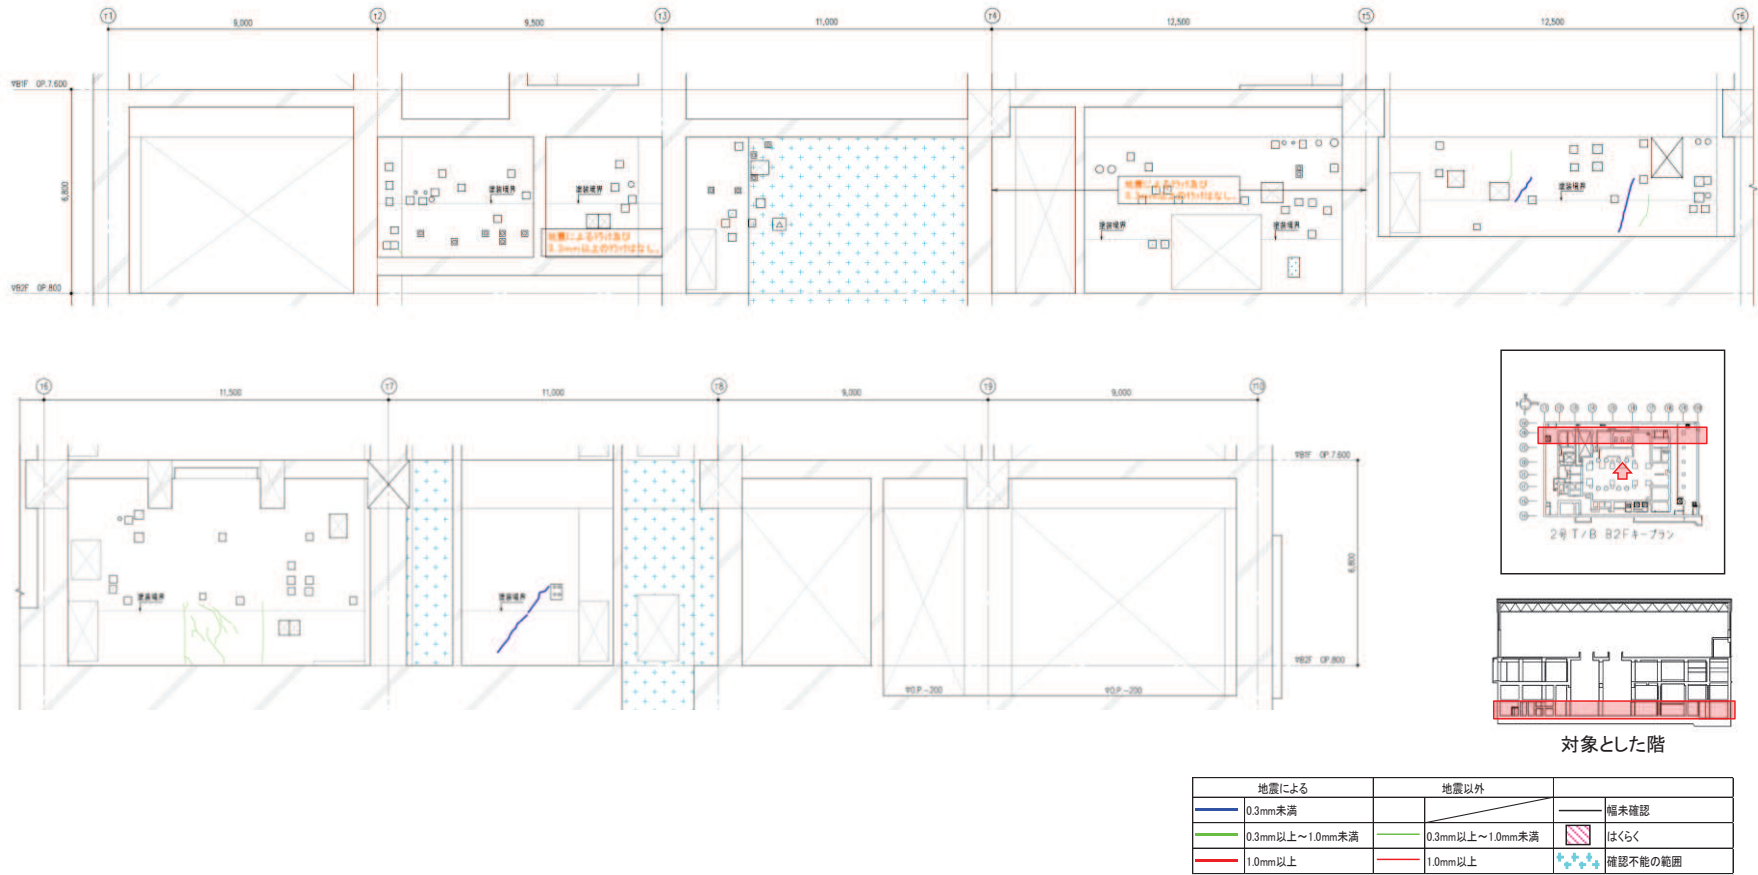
タービン建屋のひび割れ分布 耐震壁 (11) 地下 2 階 TB 通り
